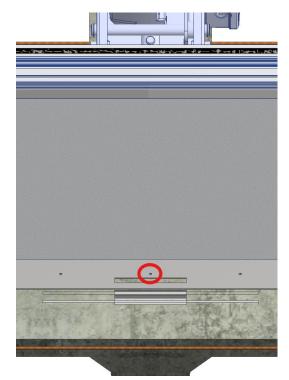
Détail de la figure 28 avec indication du trou central dans la rehausse à l'avant du WiNa Stairvent
